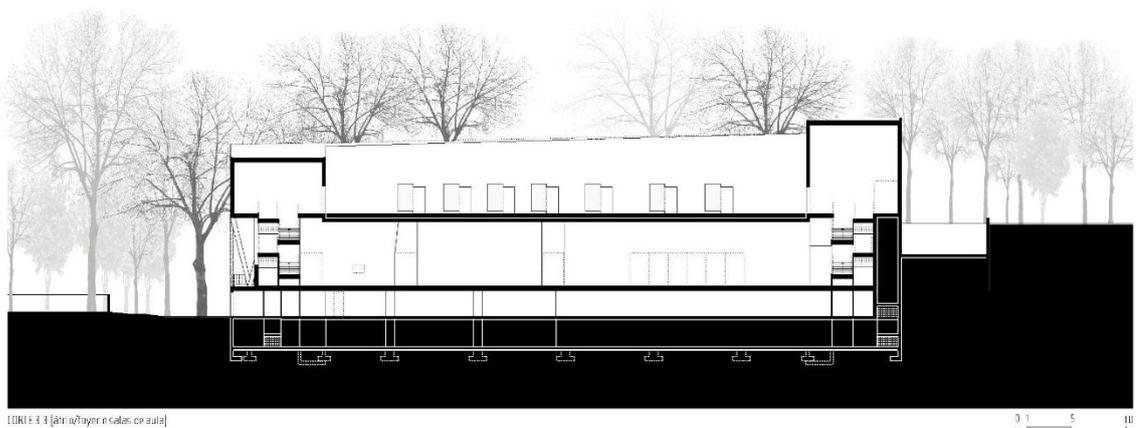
Corte Transversal (FONTE: Open Buildings, 2013).
